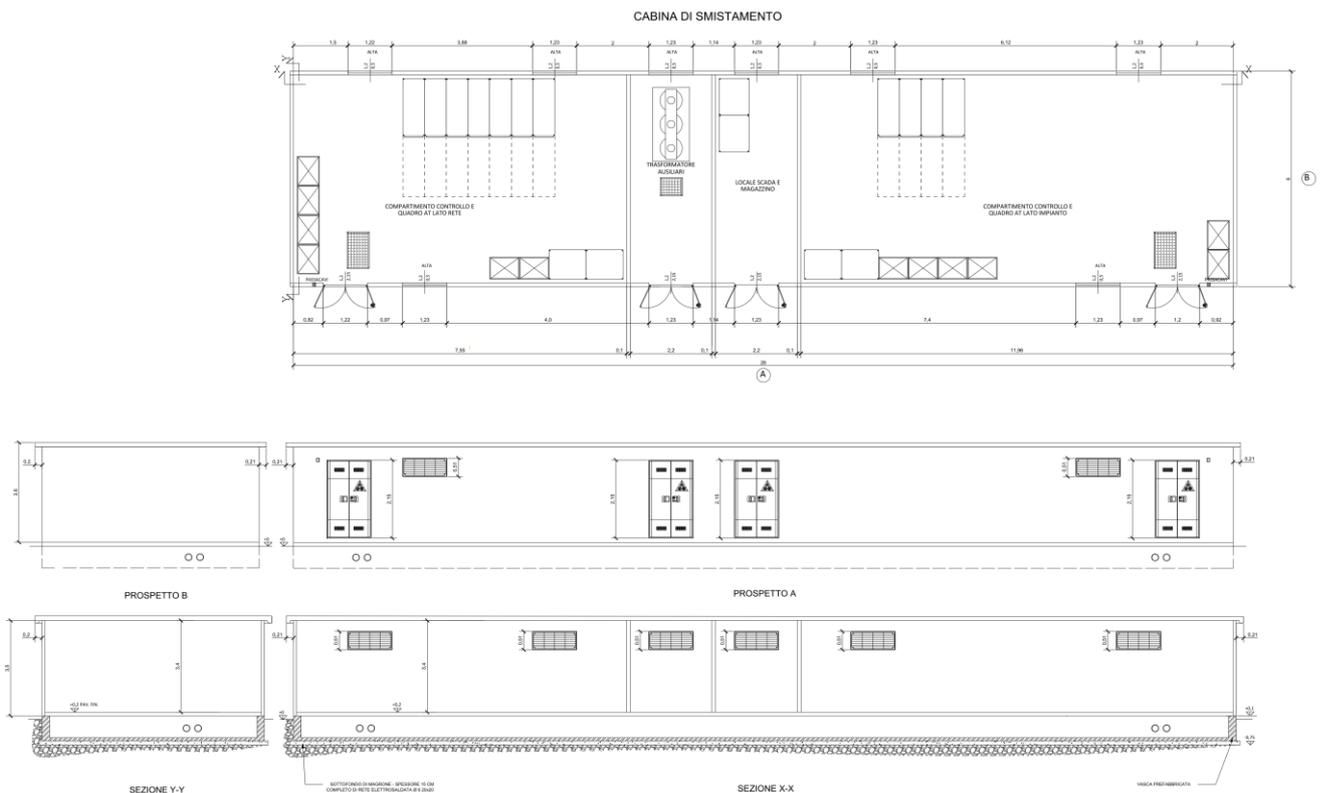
Cabina AT di smistamento - Vista in pianta e prospetto
